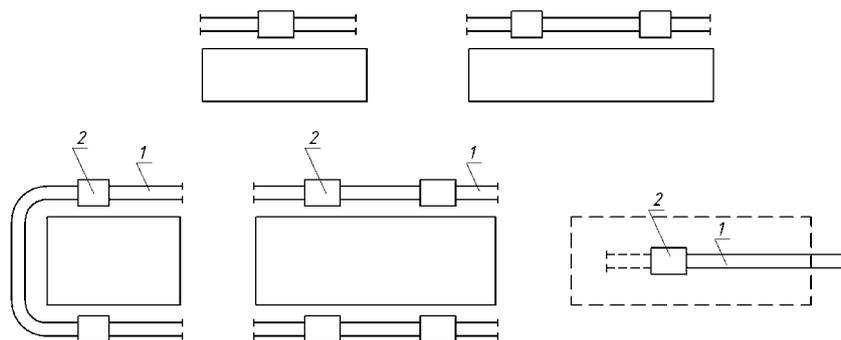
Варианты расположения монтажных кранов при монтаже многоэтажных зданий:
